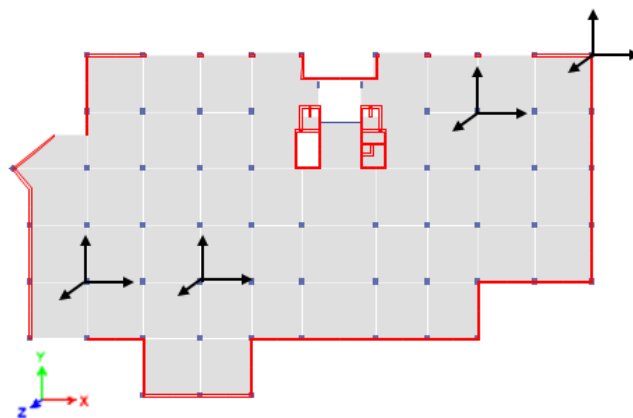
Esquema de ubicación de sensores en el Primera Planta de la estructura. Instrumentación Tipo 5.
